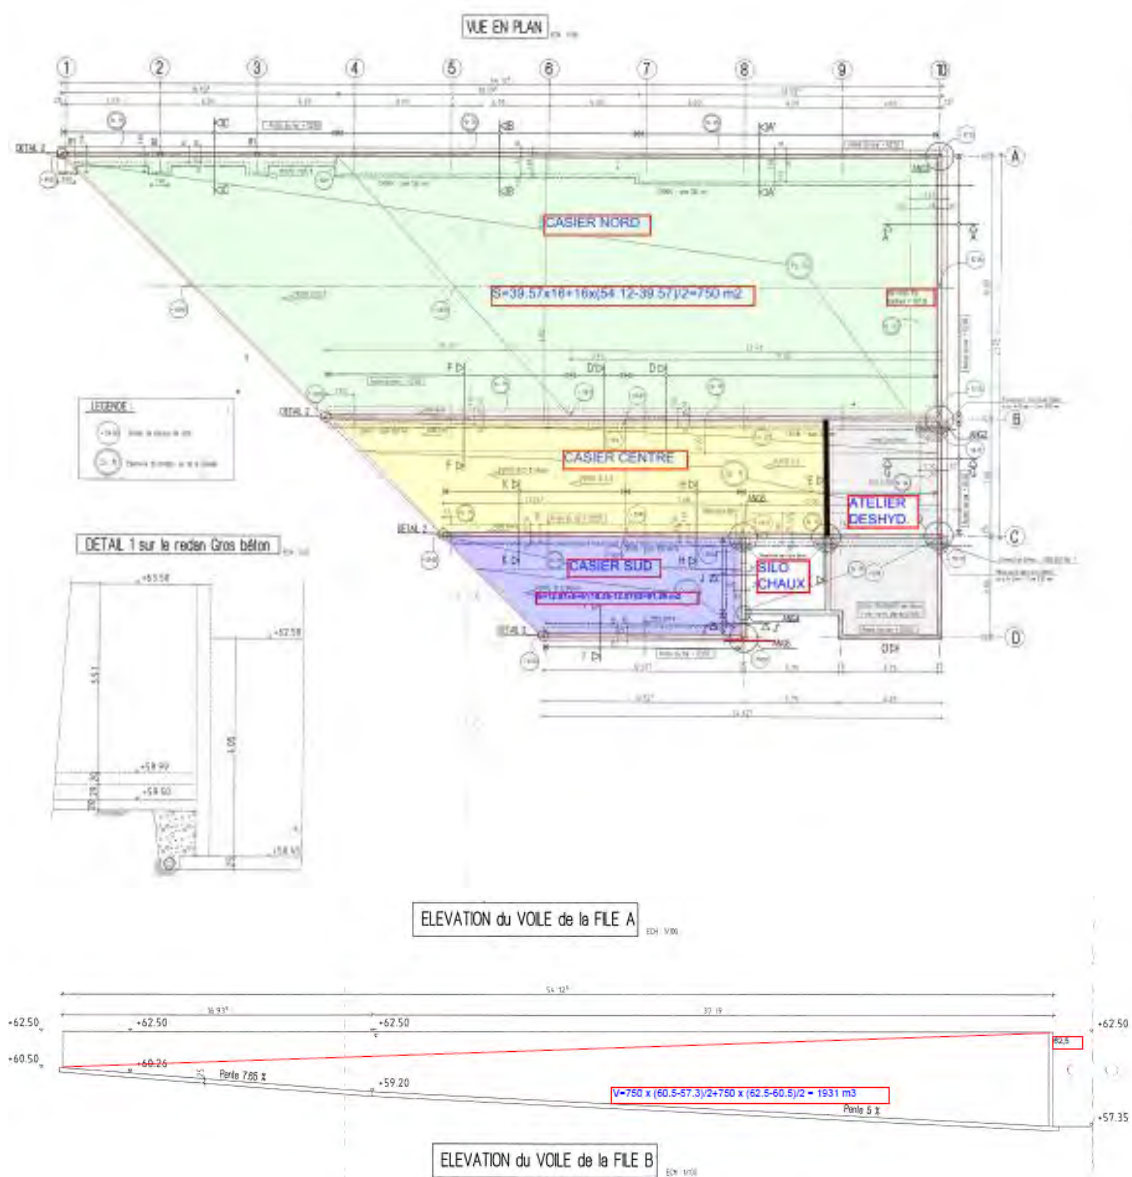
Hall de stockage des boues chaulées (ouvrage existant réutilisé)
